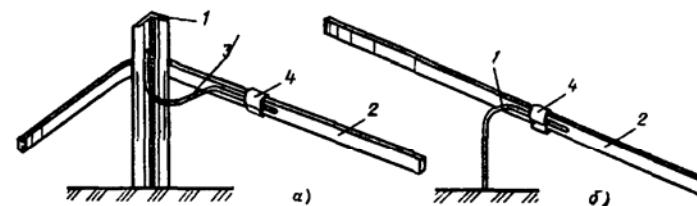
Соединение плоского горизонтального заземлителя с электродом термитной сваркой:
